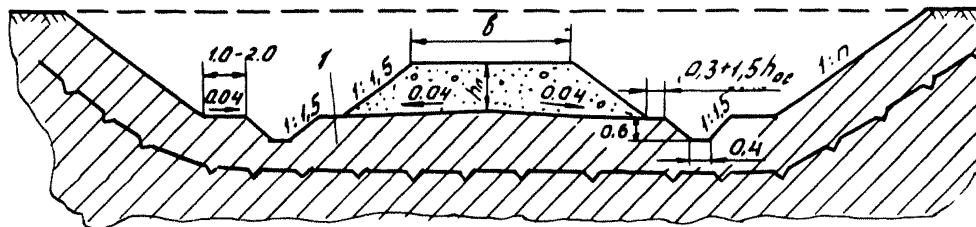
Схема мелкой выемки в пучинистых грунтах с разработкой ее под насыпь:
